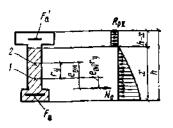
Схема усилий и эпюра напряжений в поперечном сечении элемента при расчете его по образованию трещин, нормальных к продольной оси элемента, в зоне сечения, растянутой от действия усилия предварительного обжатия 1—ядровая точка; 2—чентр тяжести приведенного сече.
